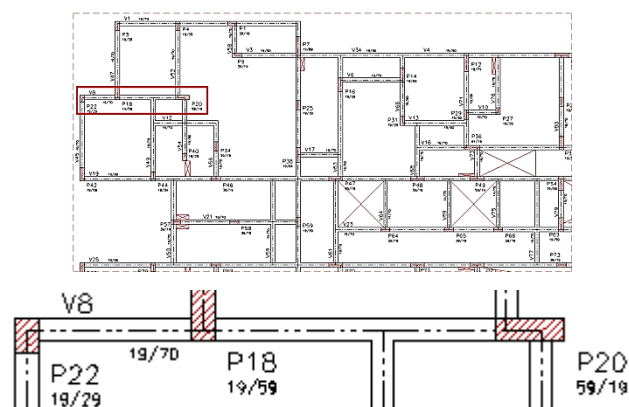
Edifício Vita Belle: localização da viga V8
